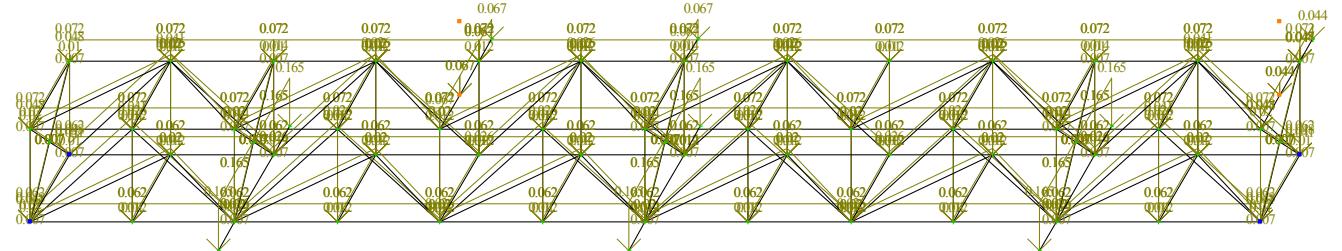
Вертикальные нагрузки от собственного веса конструкций ферм
